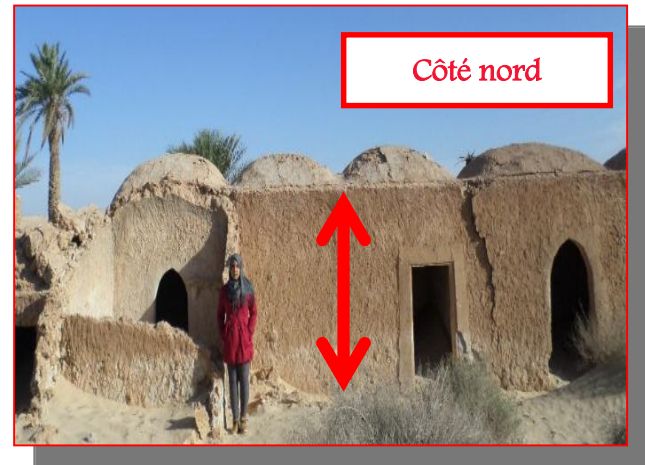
la hauteur de la maison (Sources : Auteur / 2017)
